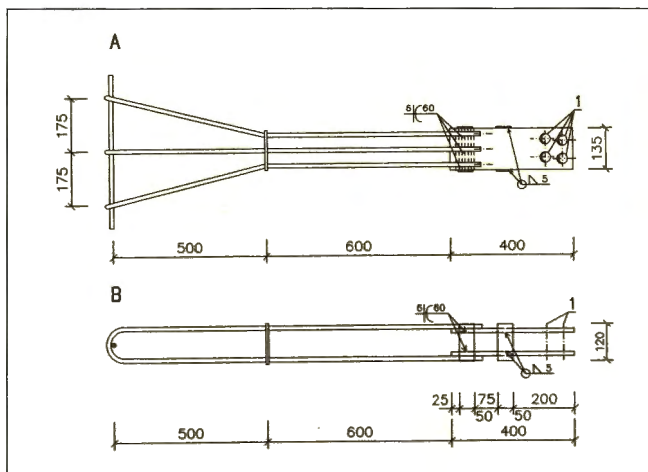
Rámová příčle – detail / Assembly of frame beam with console – detail
